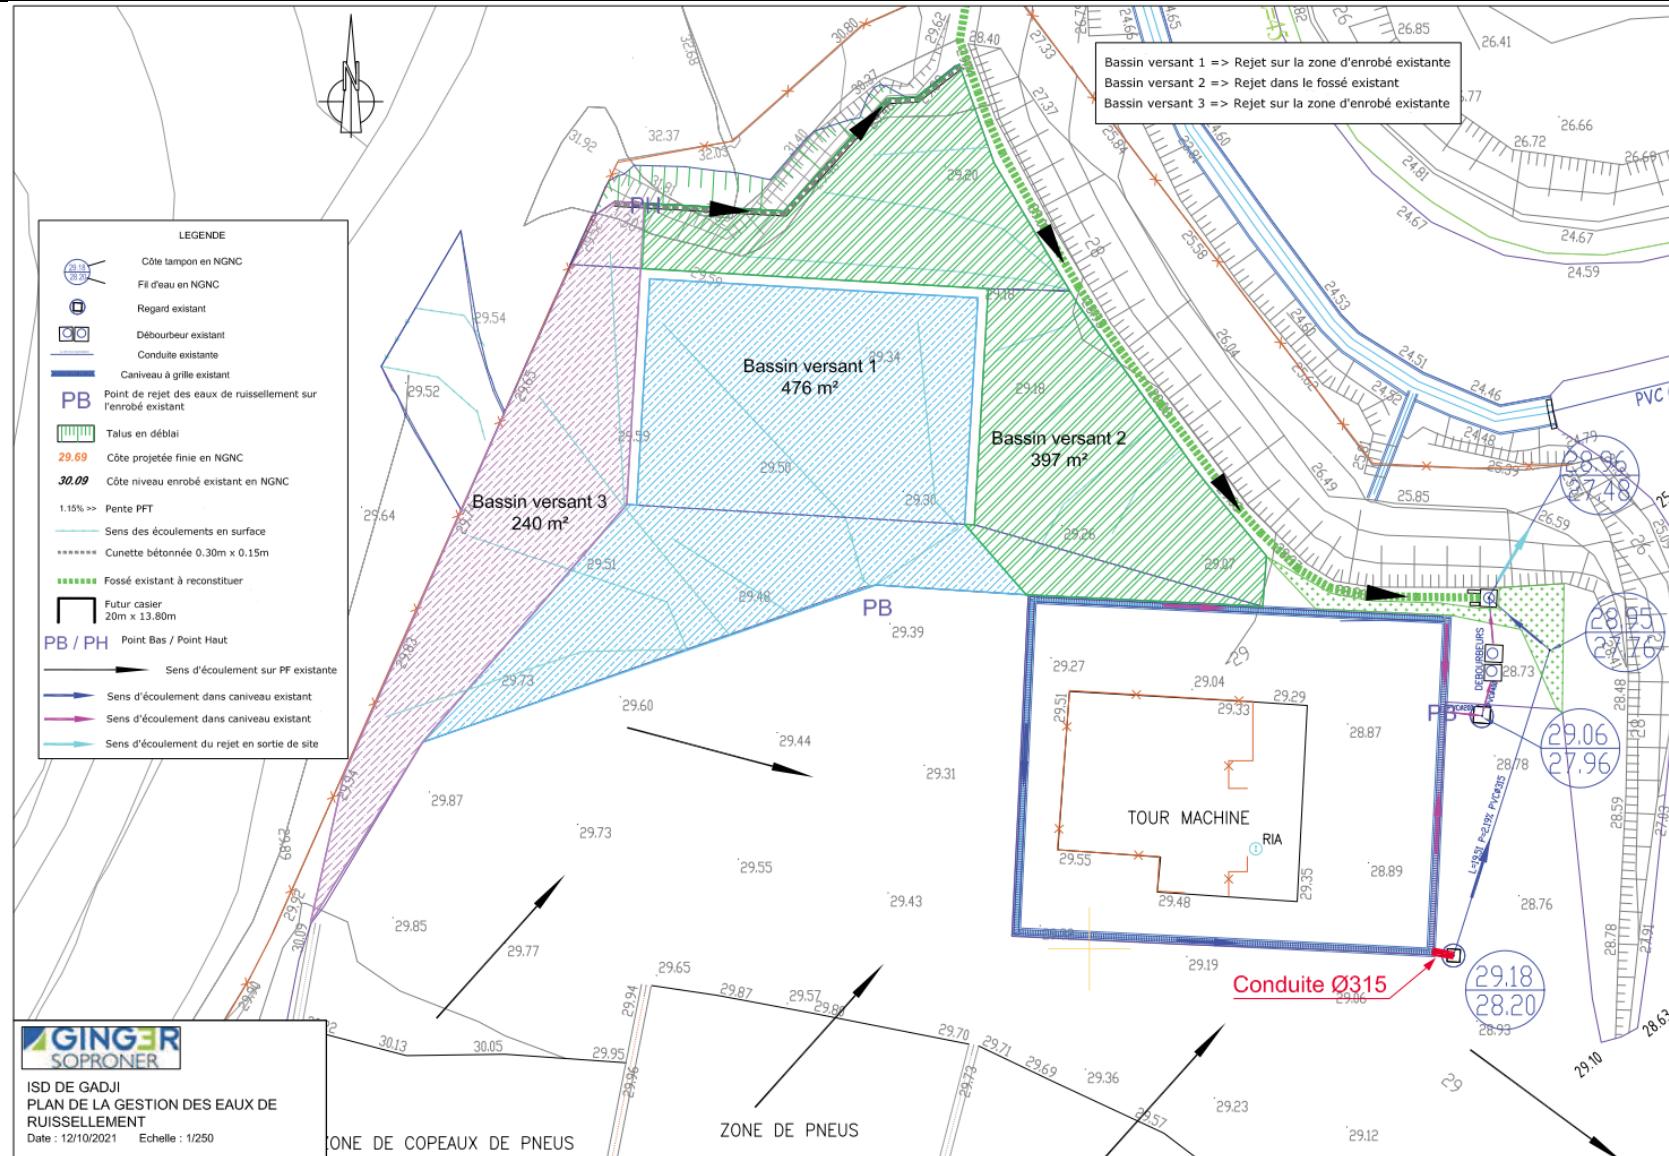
Plan de gestion des eaux au niveau de l'extension de la plateforme
